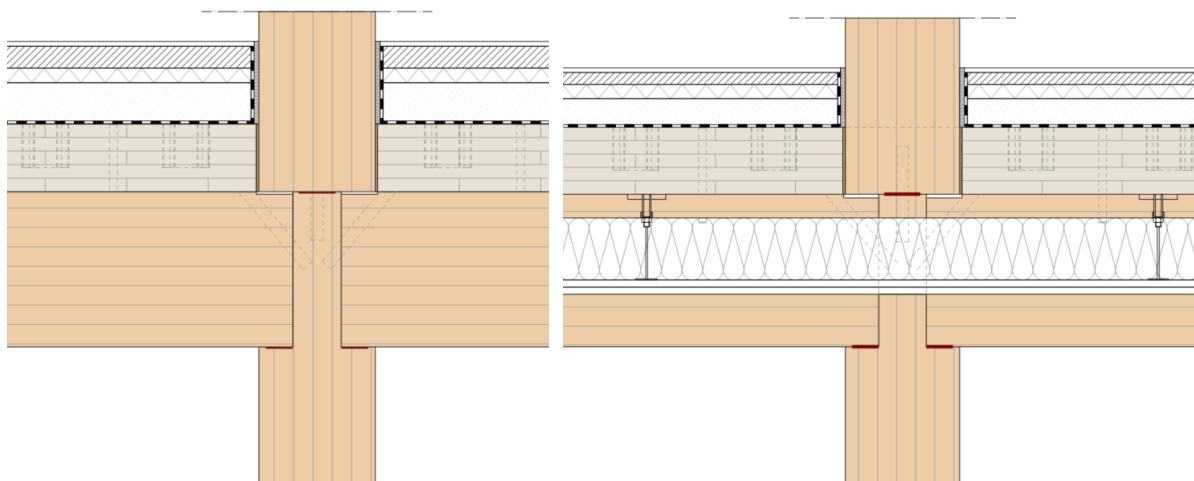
Bodenaufbauten für Büronutzung (links, ohne Unterdecke) und Flur oder Wohnnutzung (rechts, mit Unterdecke)
